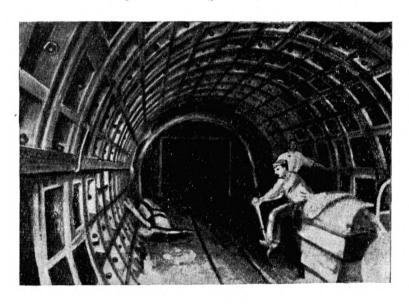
Перегонный тоннель Лондонского метрополитена с обделкой из железобетонных тюбингов
